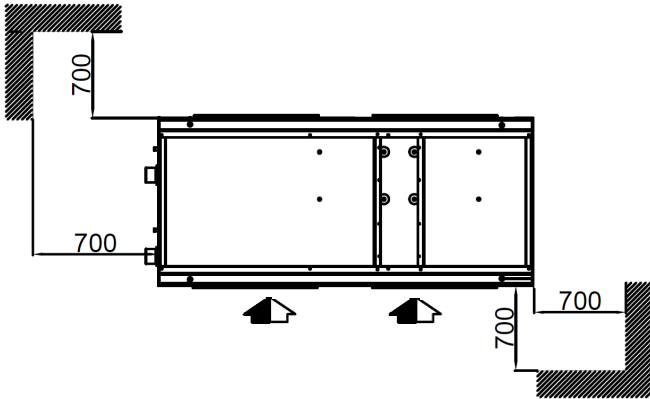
Mindestplatzbedarf [mm] für Plattform-1-Maschinen
